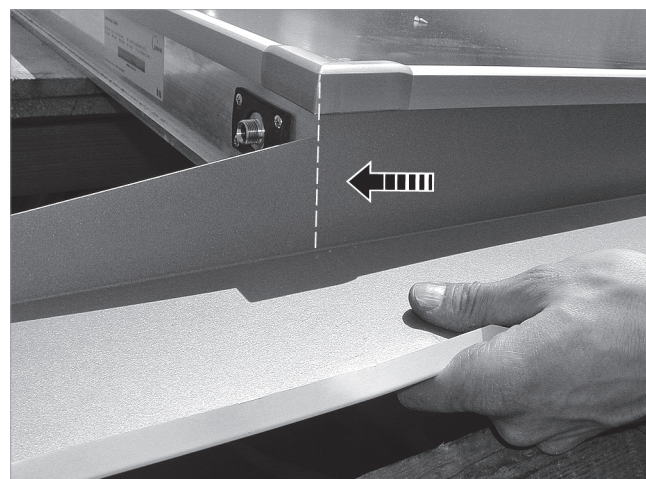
pousser la partie supérieure vers le haut, contre la butée
